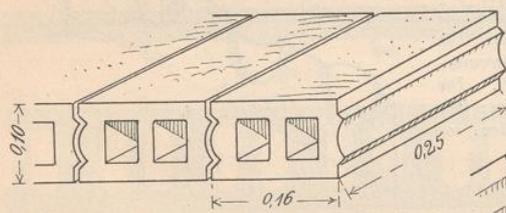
Decke nach Metsch, ebenfalls aus porigen Lochsteinen mit profilirten, in einander passenden Seitenflächen, die jedoch nicht so stark geschweift sind, daß viel Bruch entsteht. 1 qm Decke erfordert 23 Steine, ein Stein wiegt 4 bis 5,1 kg. Eine Decke, deren Gesamtlast 500 kg/qm beträgt, erhält I-Träger, Normalprofil 14 bei 1,0 m Trägerabstand und 3,0 m freier Trägerlänge, bei Normalprofil 30 entsprechend 2,0 m und 6,0 m. Für Gesamtlast 600 kg/qm entsprechend Normalprofil 15 1,0 m und 3,0 m, bei Normalprofil 32 2,0 m und 6,0 m. Für Gesamtlast 750 kg/qm bei Normalprofil 16 1,0 und 3,0 m, bei Normalprofil 34 2,0 m und 6,0 m.
